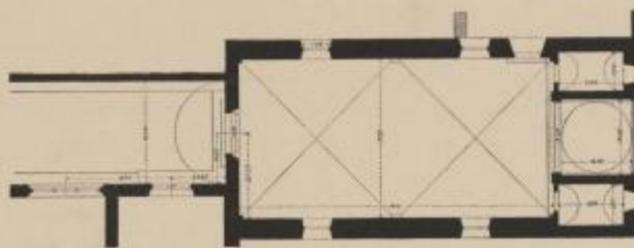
GRUNDRISS DER KAPELLE MEDICI IN S. CROCE ZU FLORENZ.
